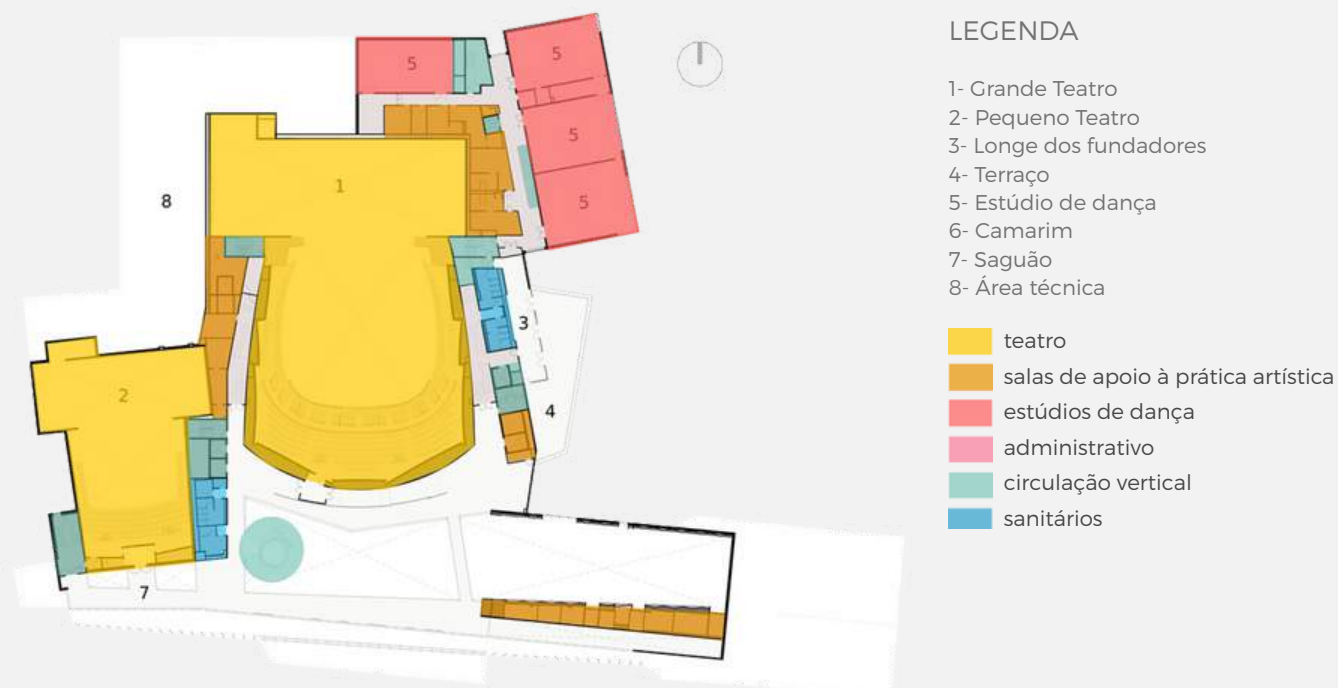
Planta baixa 2ª pavimento. Fonte: Archdaily.
